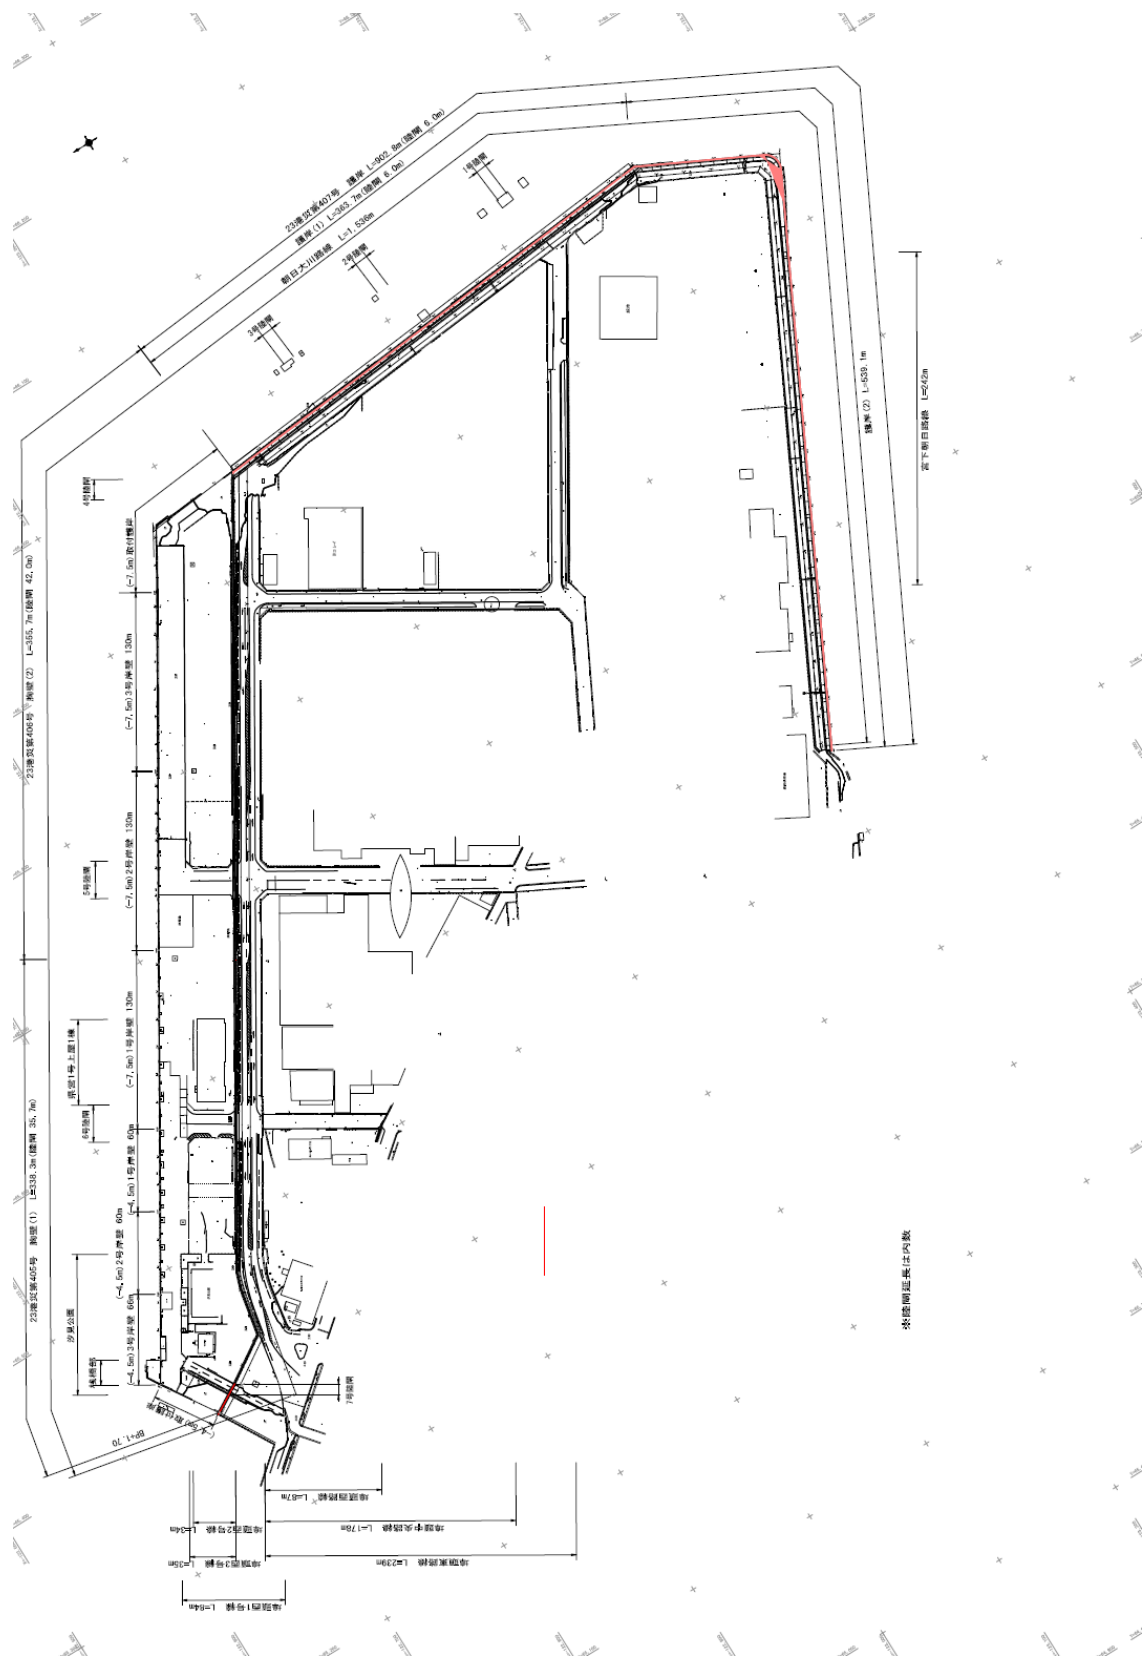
76 No. 2 朝日地区護岸の平面図（復旧後）
